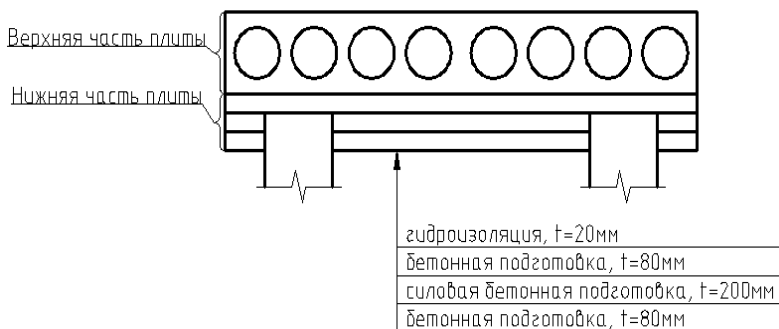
Конструктивная схема плитно – свайных фундаментов с силовой бетонной подготовкой.
